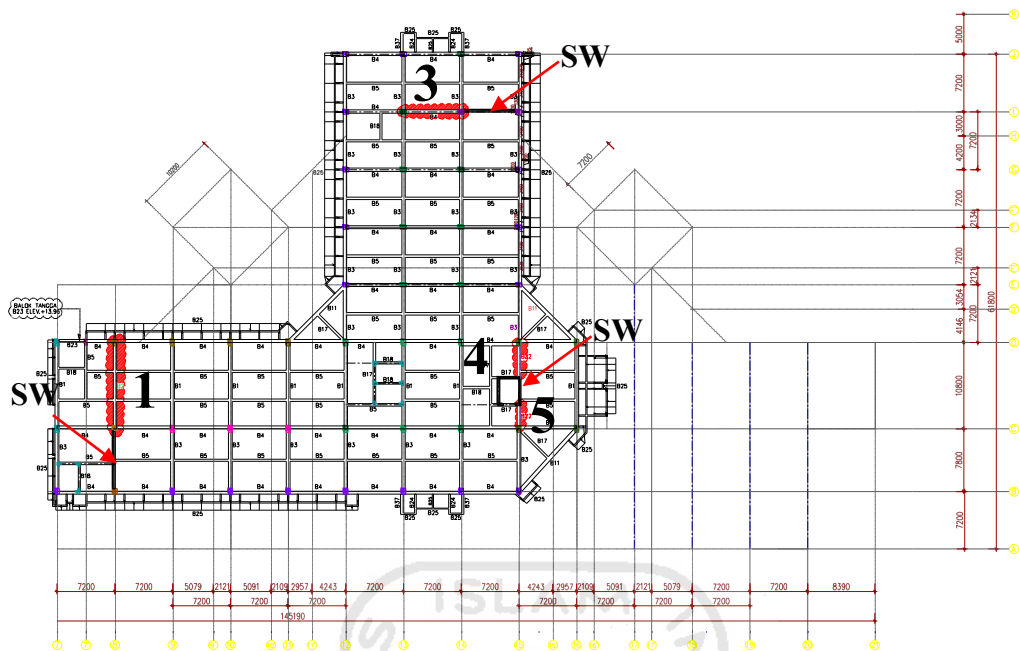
29 Balok yang Berpotensi Menjadi Elemen Kolektor pada Lantai 2
